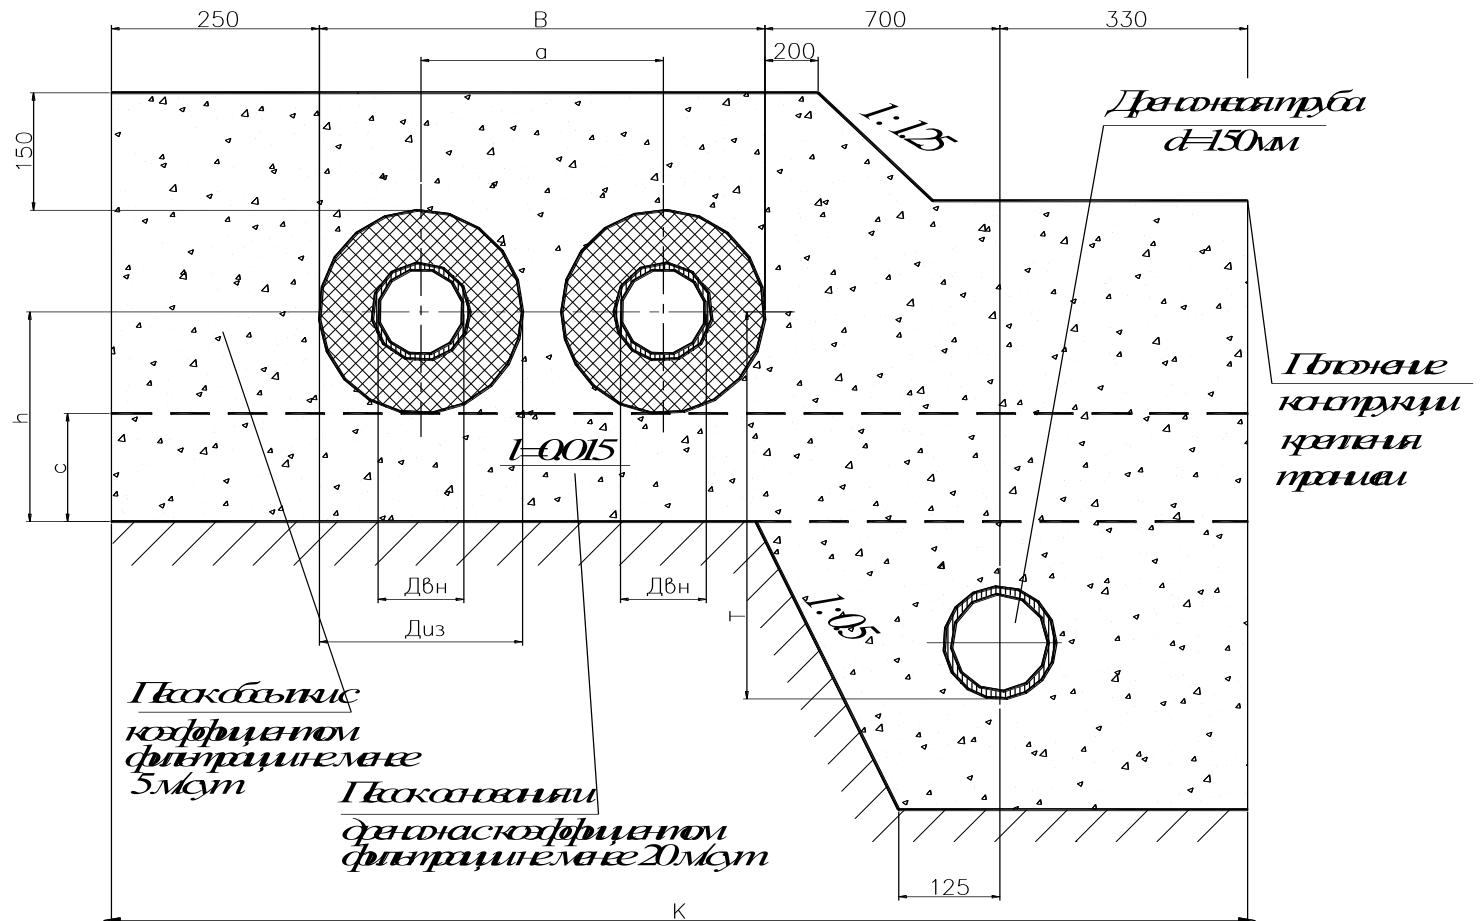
Бесканальная прокладка теплопроводов в ППМ изоляции в траншеях с креплениями с устройством продольного дренажа.
